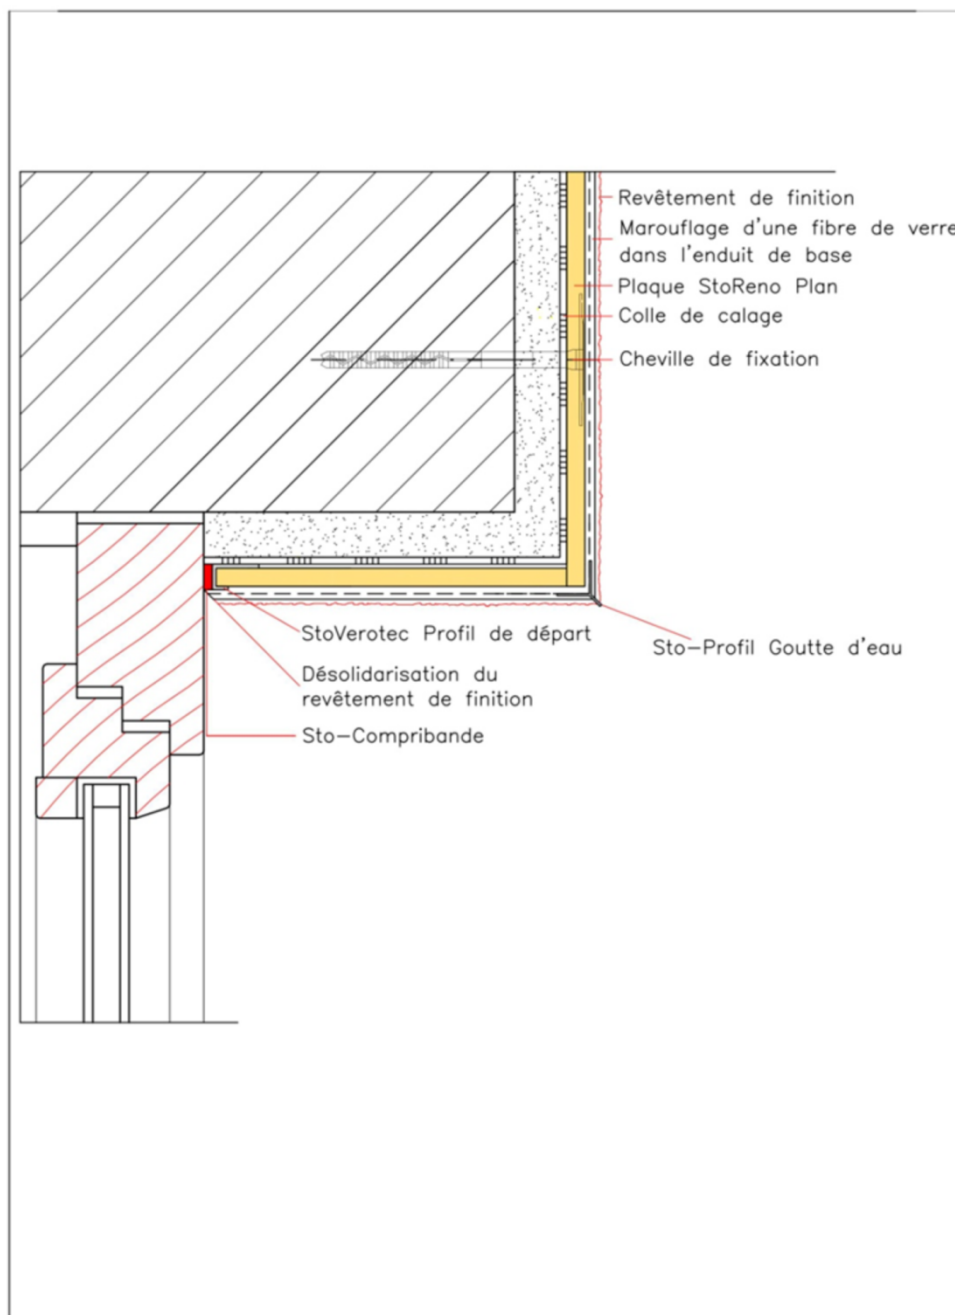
is : Arrêts horizontaux tablettes et linteaux de fenêtre
